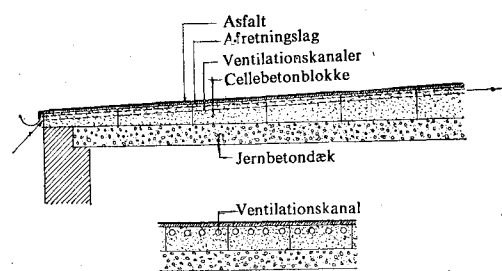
Jernbetontag med Afretningslag af porøs Beton og med færdigstøbte Isolationsplader med Ventilationskanaler.
